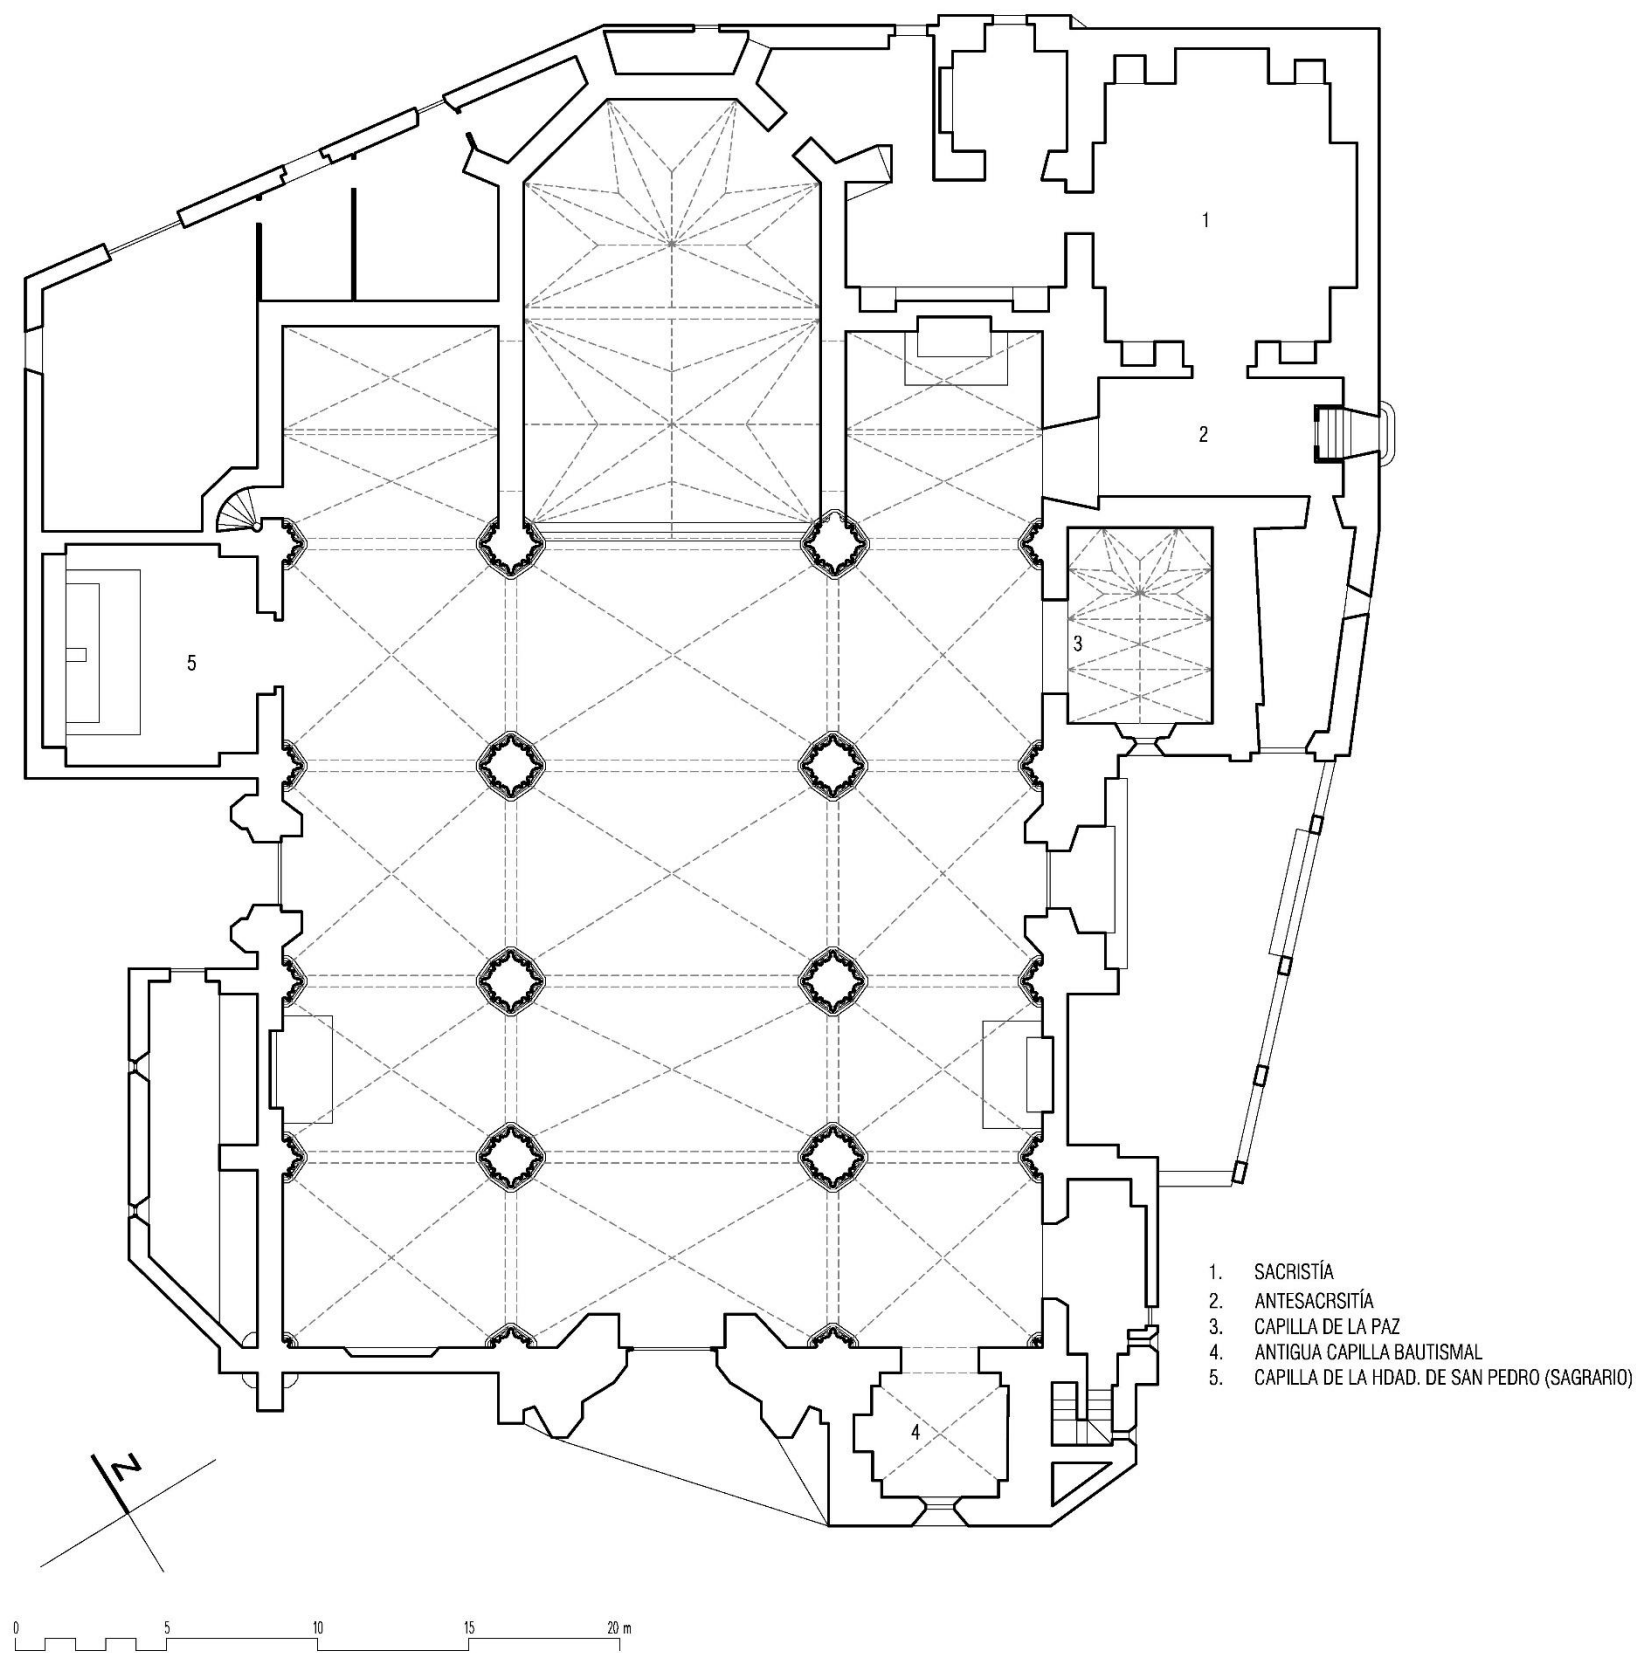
Planta general. Iglesia parroquial de Santiago. Jerez. (Estado del edificio en 1961 según planimetría de Pons Sorolla)
